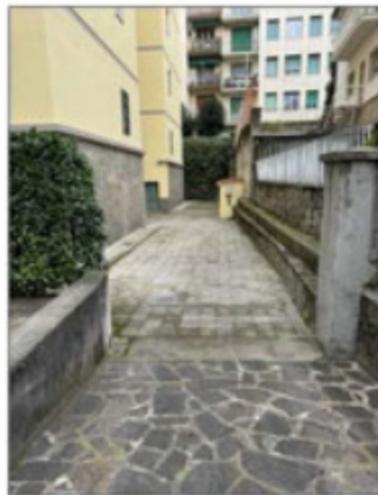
e n. 14 – Ingresso da Via Crimea
